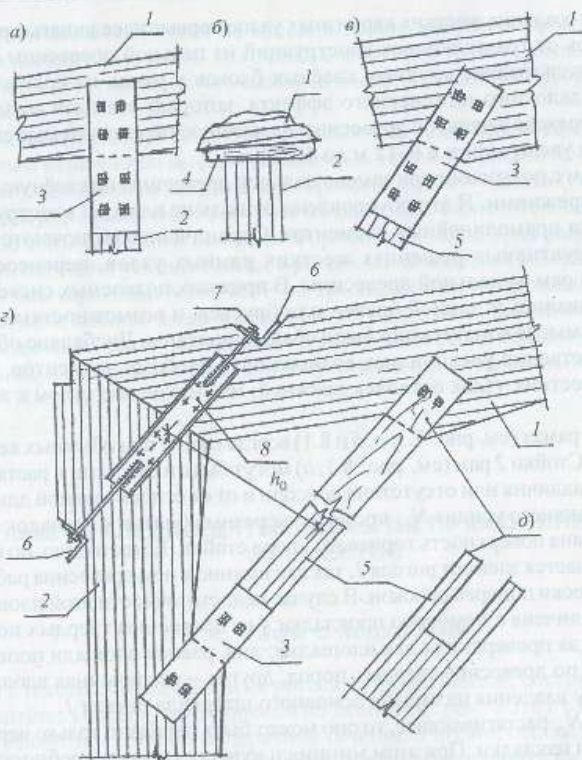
Жесткие узлы рам с подкосами: а — соединение ригеля 1 со стойкой 2 при помощи накладок 3 на болтах; б — вариант увеличения площади смятия древесины в ригеле через прокладку 4 из древесины твердых пород; в — узел примыкания подкоса 3 к ригелю; г — жесткий узел с коротким подкосом; д — вариант примыкания подкоса 3 к ригелю без накладок; б, 7, 8 — детали металлического хомута
